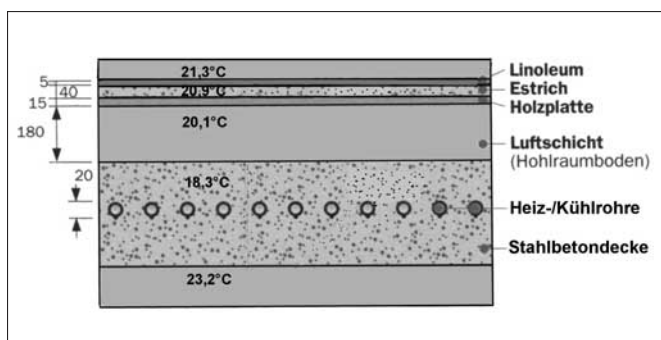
Installation in die Decke integriert (Bauteilaktivierung)
